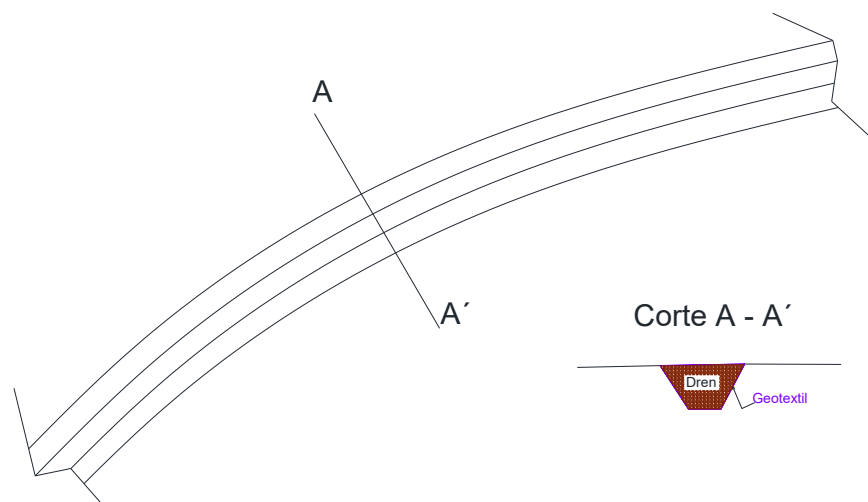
Dren de zanja dotado de geotextil como filtro.
